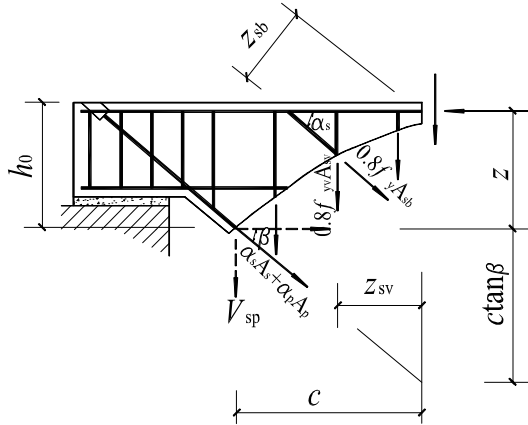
受拉边倾斜的受弯构件的斜截面受剪承载力计算
